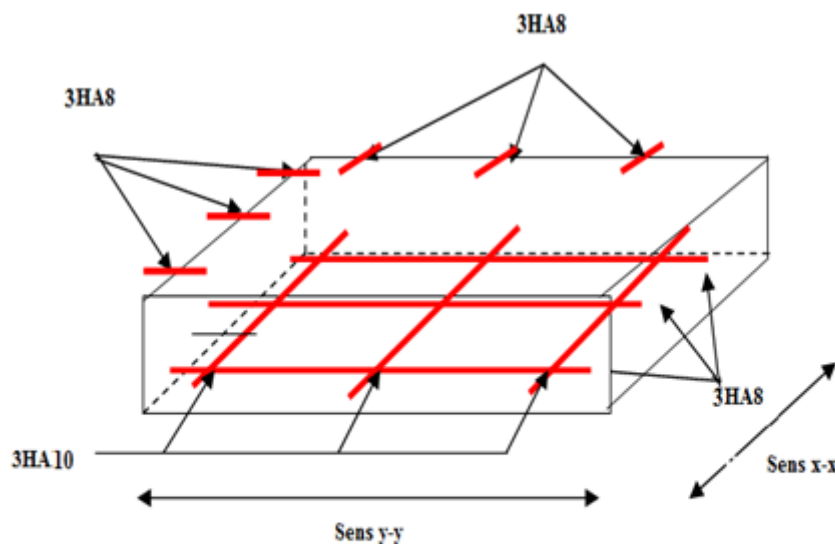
Schéma de ferrailage de la dalle pleine du local machinerie.
